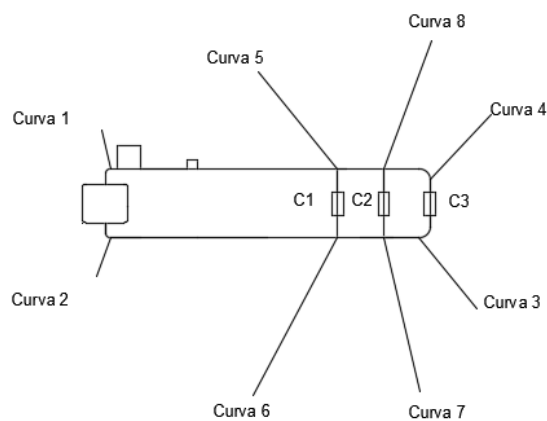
Vista de cima da instalação de água quente que se pretende dimensionar.
